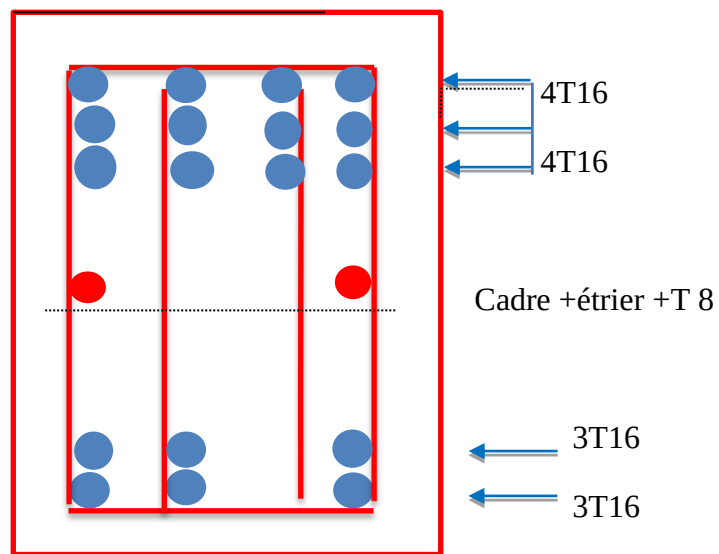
Ferrailage de la poutre de libage (sens transversale)
